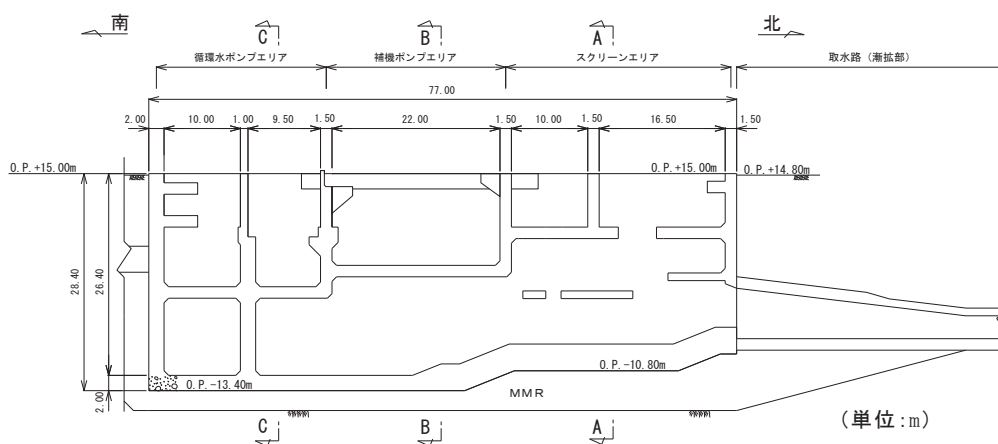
海水ポンプ室断面図 (E-E 断面, 南北)
